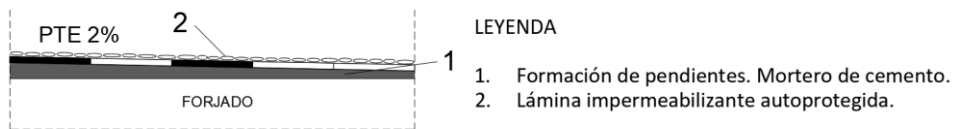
Detalle de cubierta en patios, casetón, balcones.
